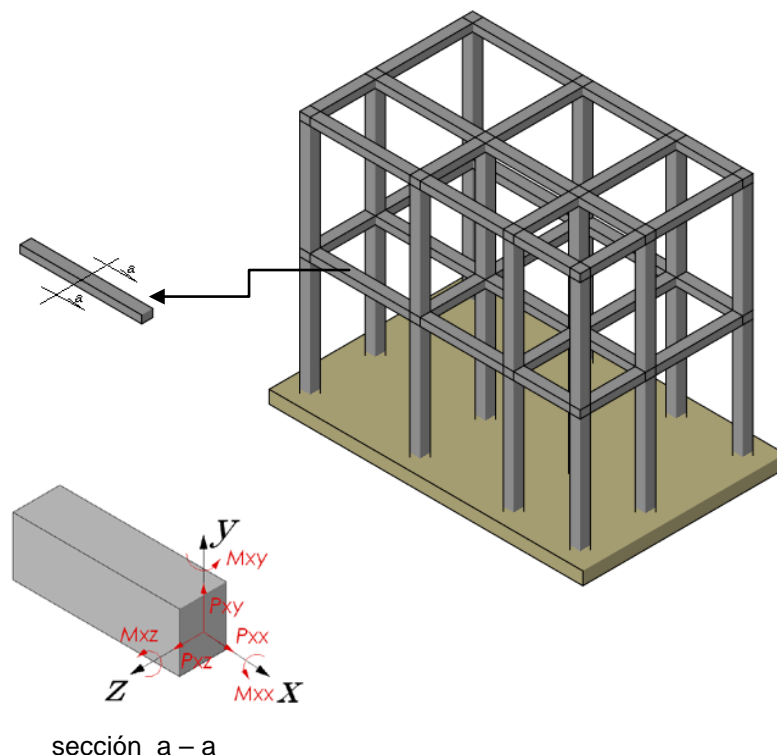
Esfuerzos en un elemento del conjunto estructural tridimensional (elemento viga)
